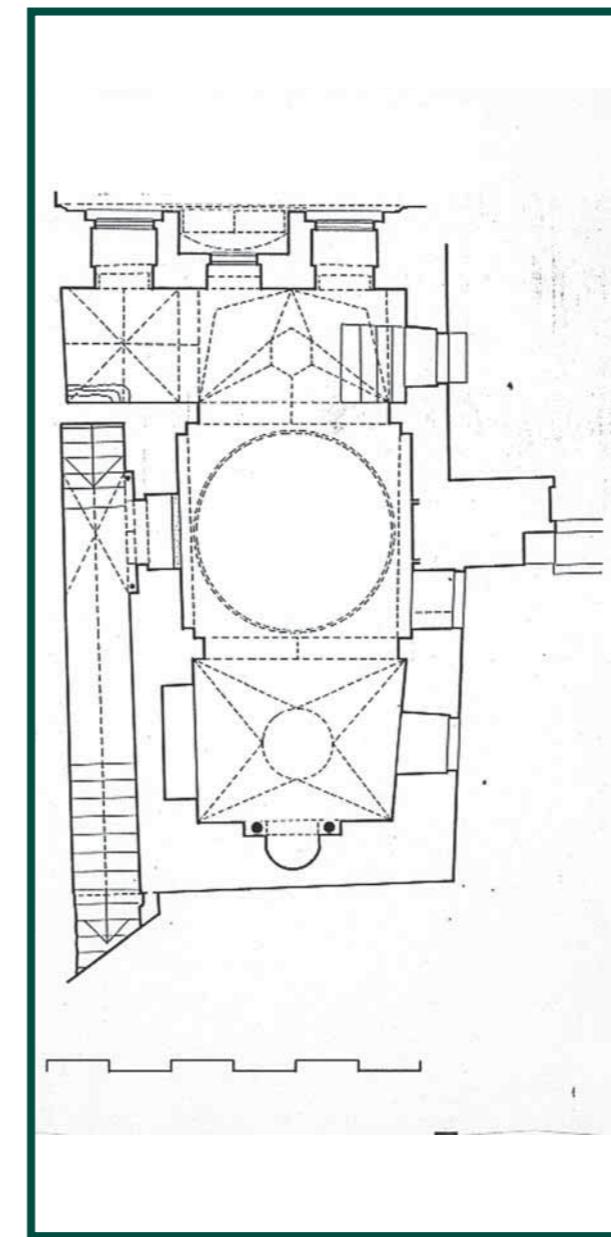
مخطط الطابق الأول في دار السنت طنشق المظفرية
